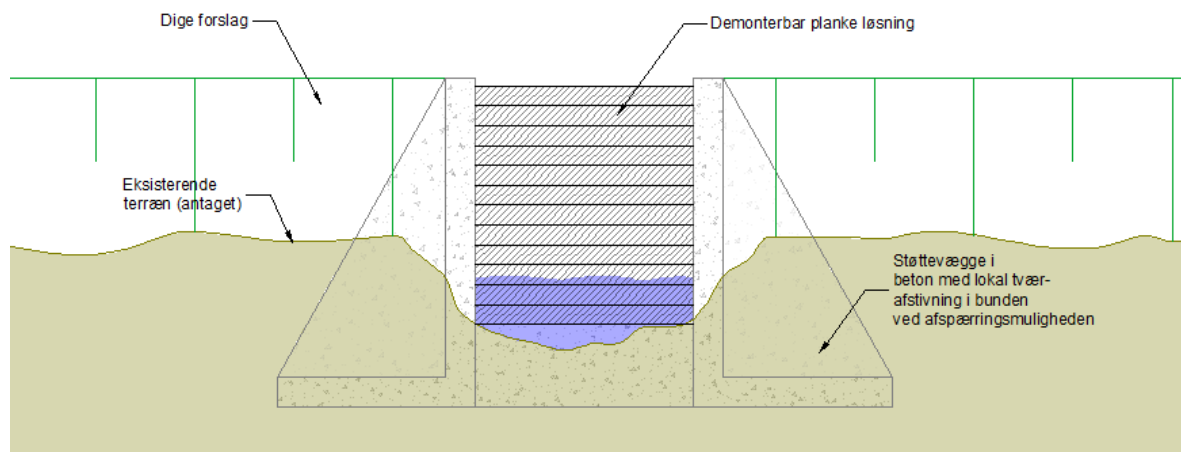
Forslag til dige krydsning af Olsbækken. Planker kan også placeres på landsiden af betontrug.
